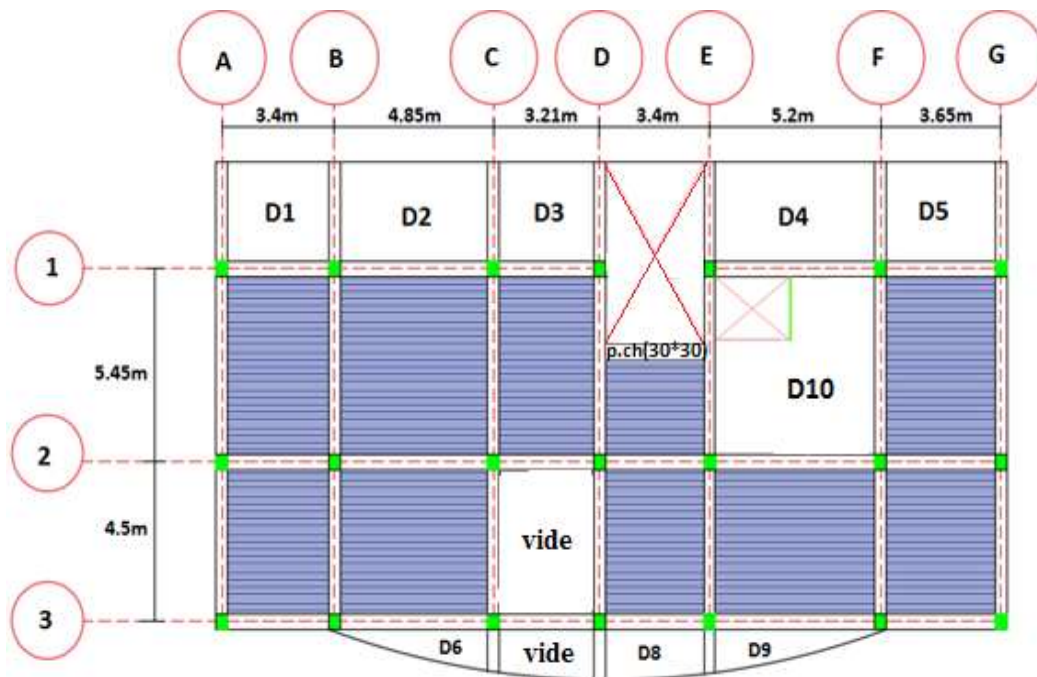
disposition des poutrelles dans la terrasse inaccessible.
